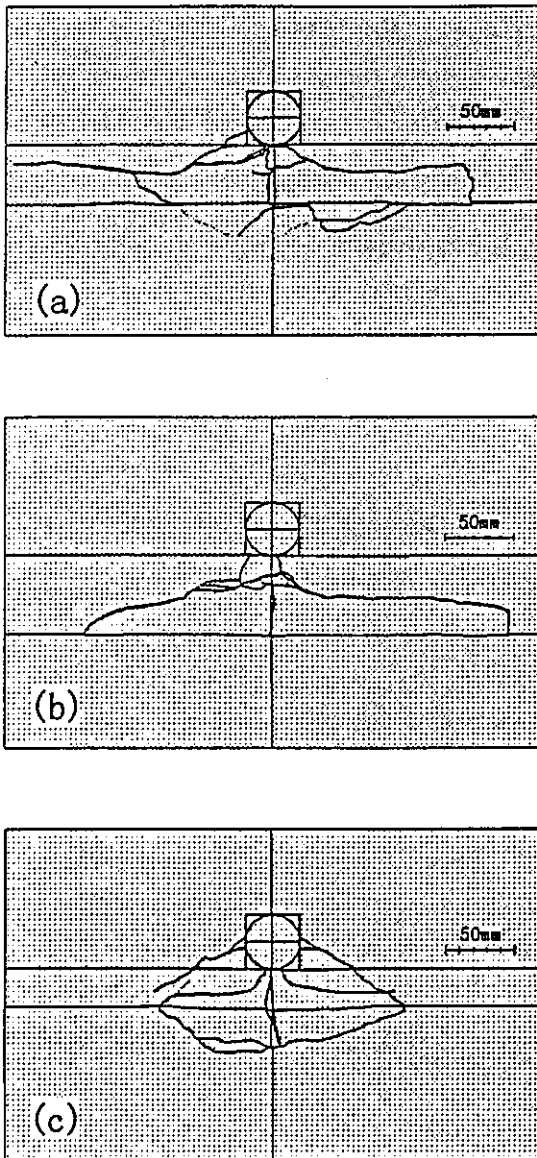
二層傾斜地盤 破壊状況 (平面図)
